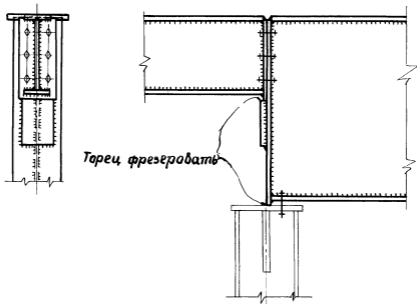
Опирание разрезных подкрановых балок на колонны:
